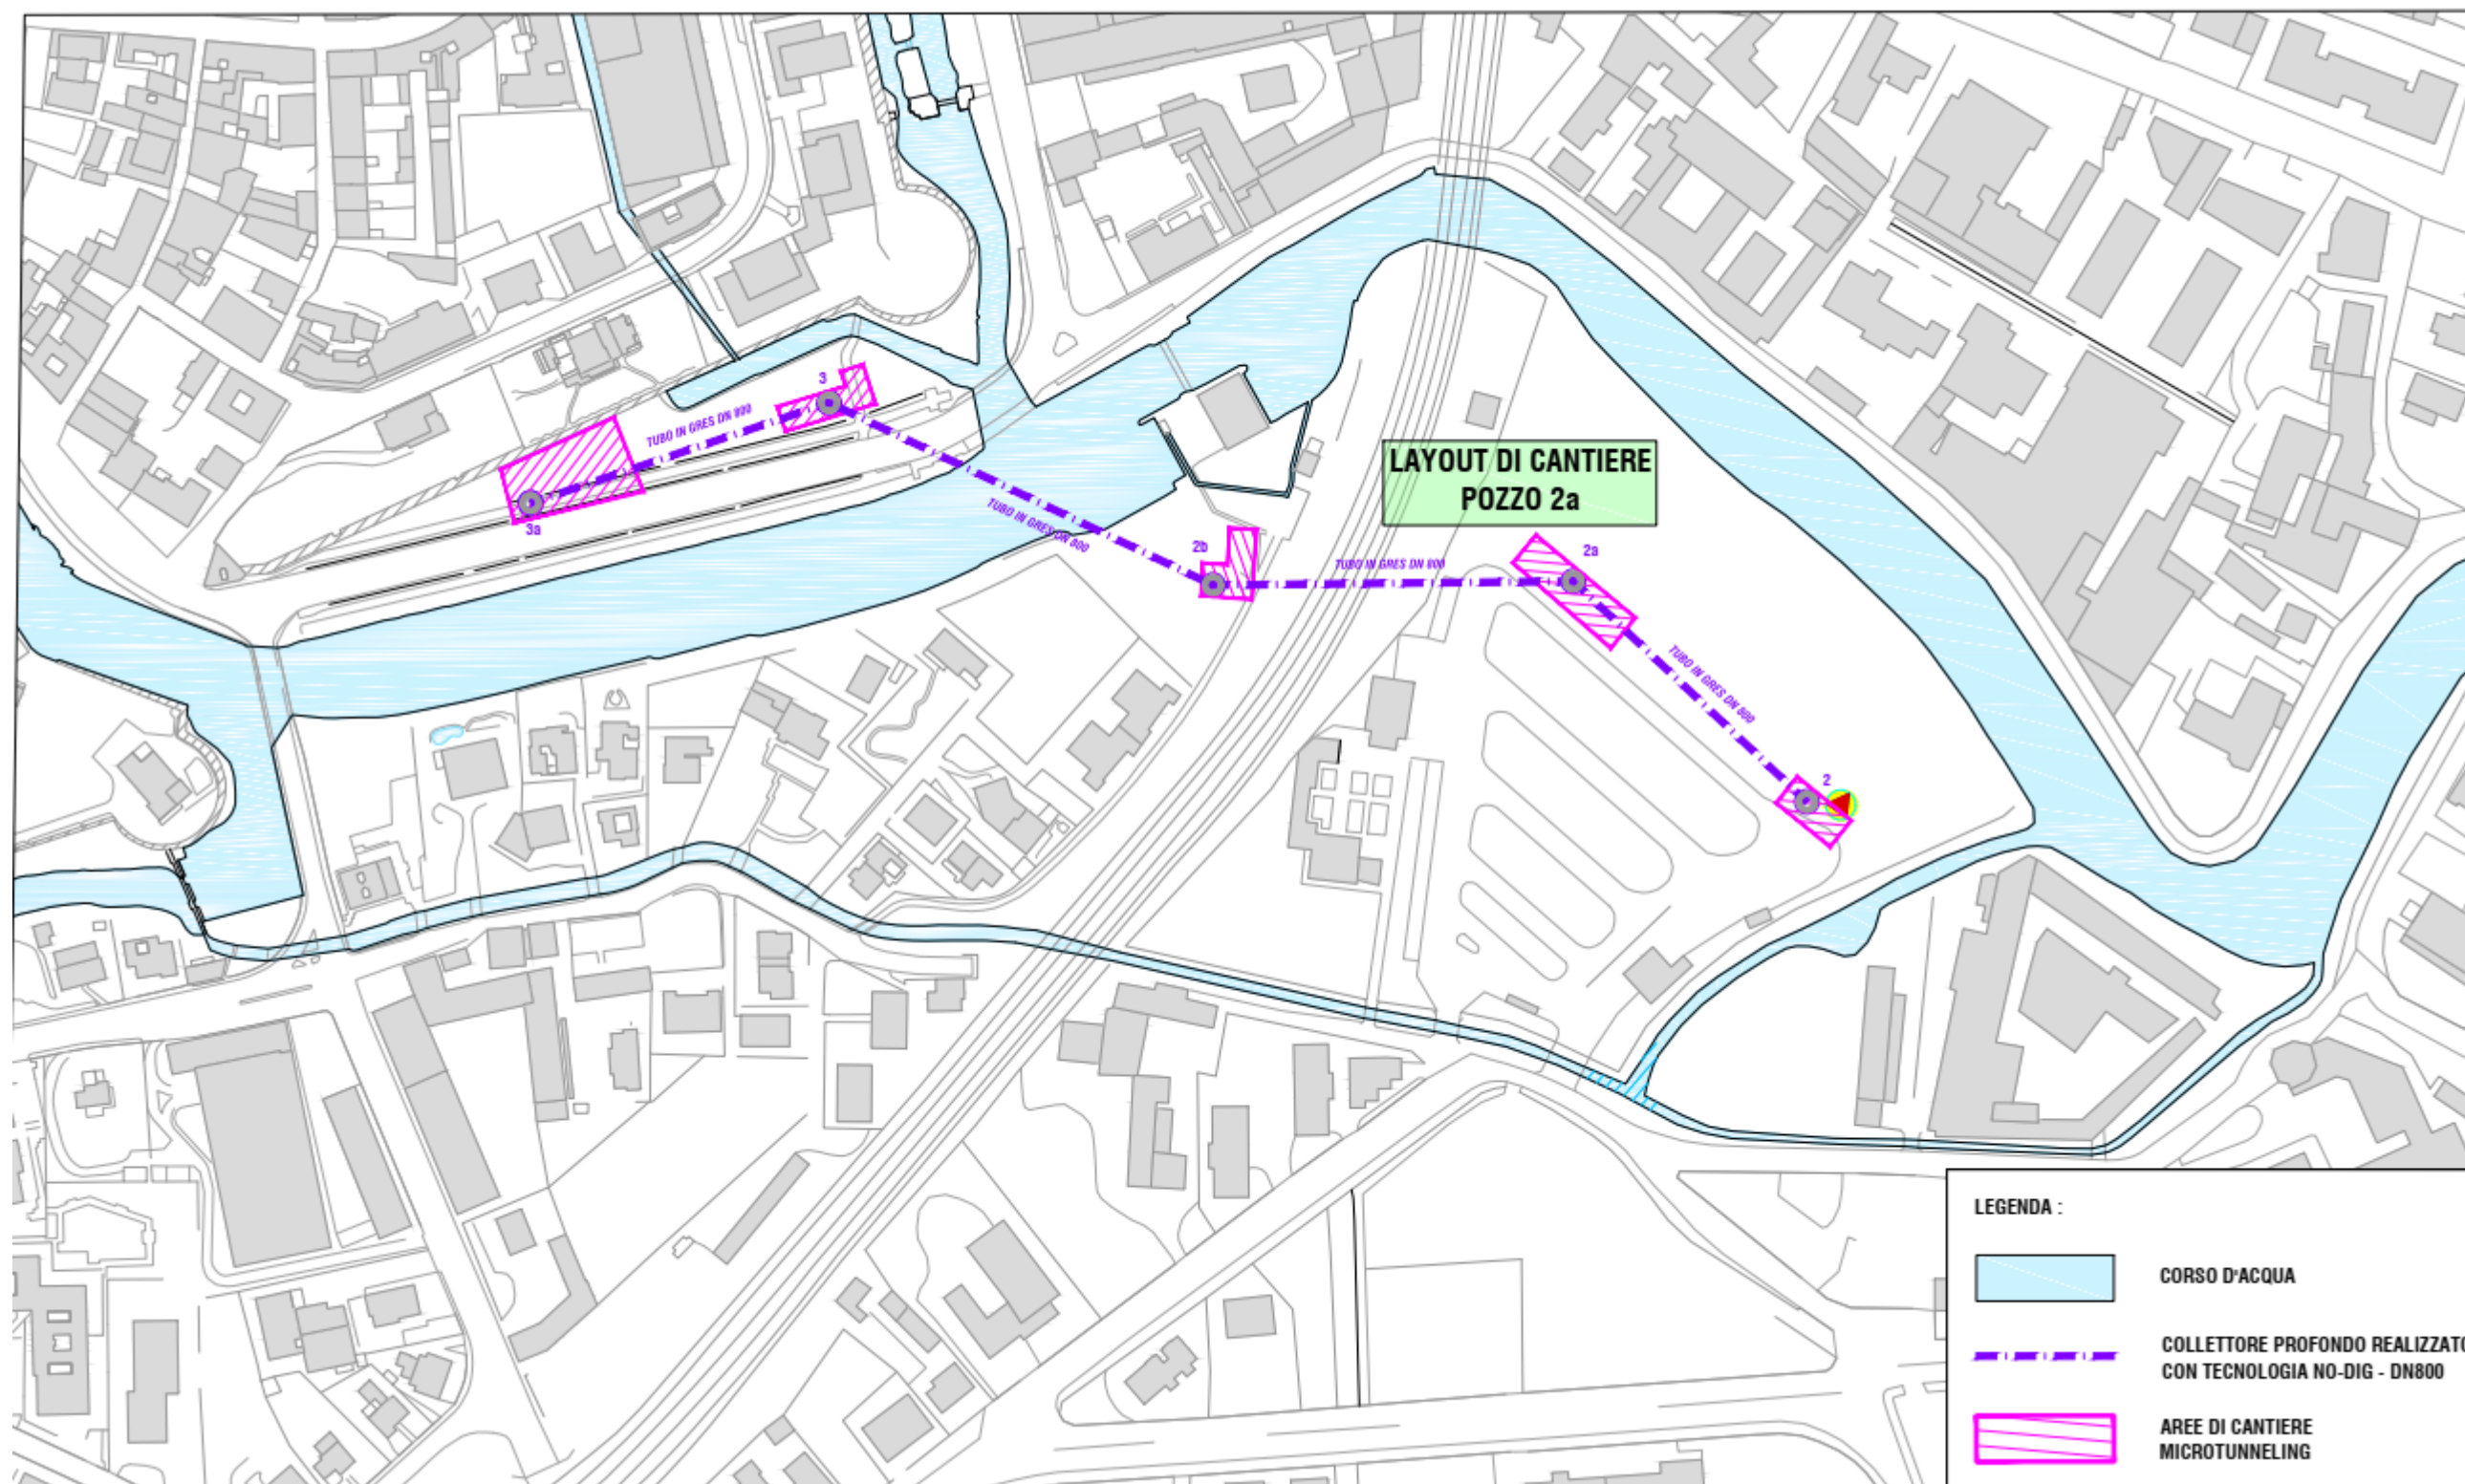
L : Inquadramento planimetrico area cantiere POZZO S02a
